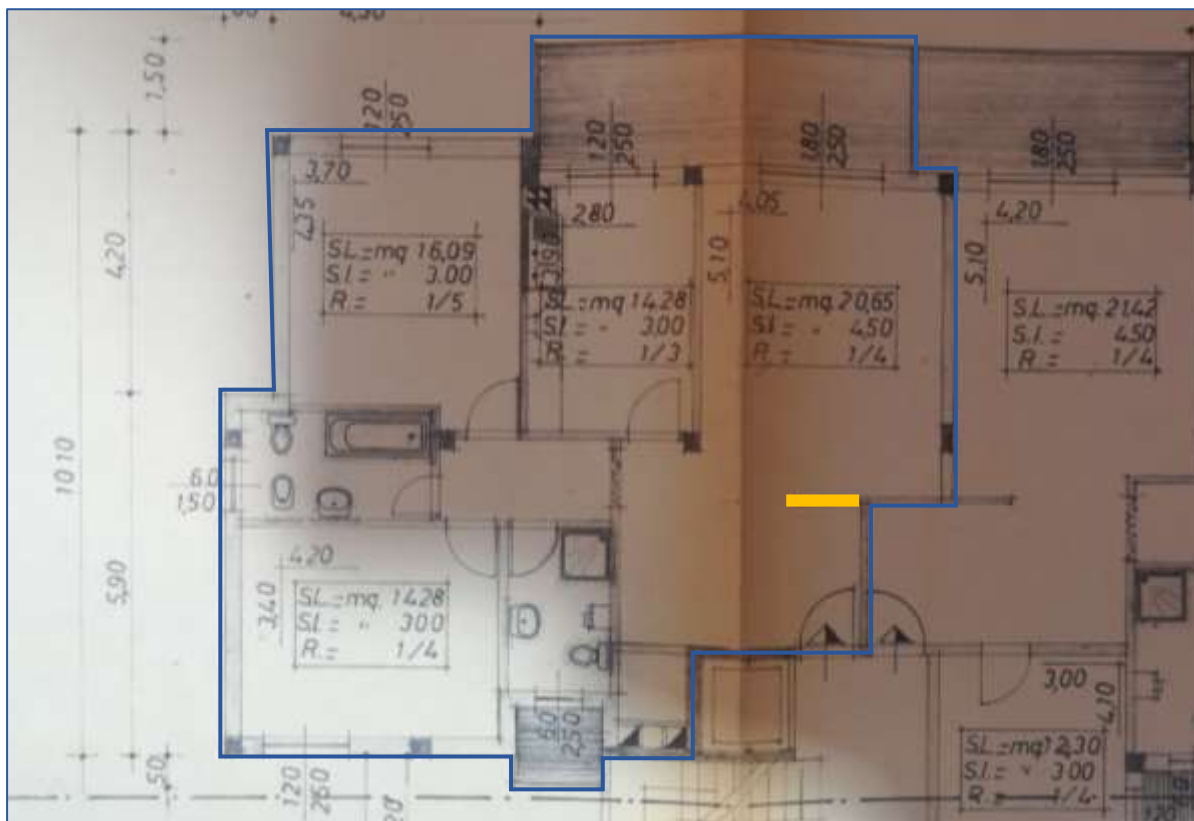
Estratto tavola di progetto PIANO TIPO con (in giallo) indicazione del tramezzo non rilevato in fase di sopralluogo
